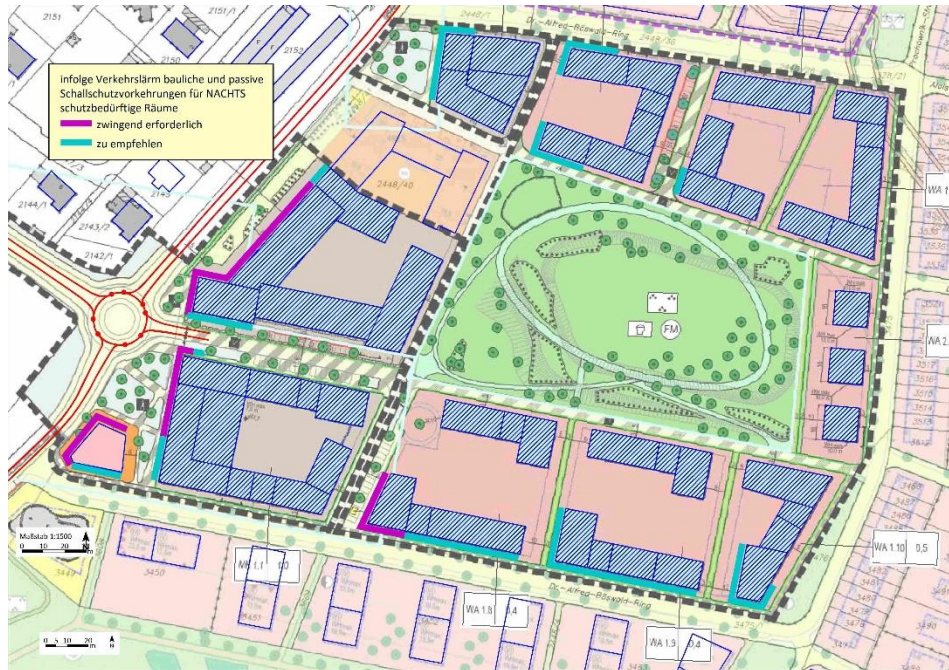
Fassadenteile mit Pflicht und Empfehlung für bauliche und passive Schallschutzvorkehrungen NACHTS
